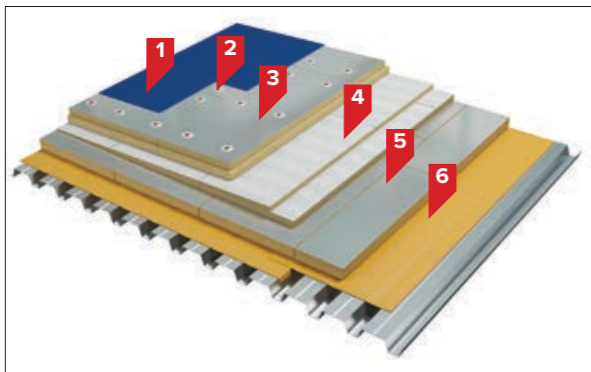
Рекомендуемая схема крепления плит теплоизоляционных PIR
